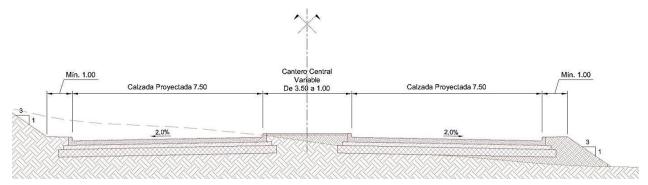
Perfil tpo de la avenida, con cantero central que prevée futuros giros a la izquierda.
